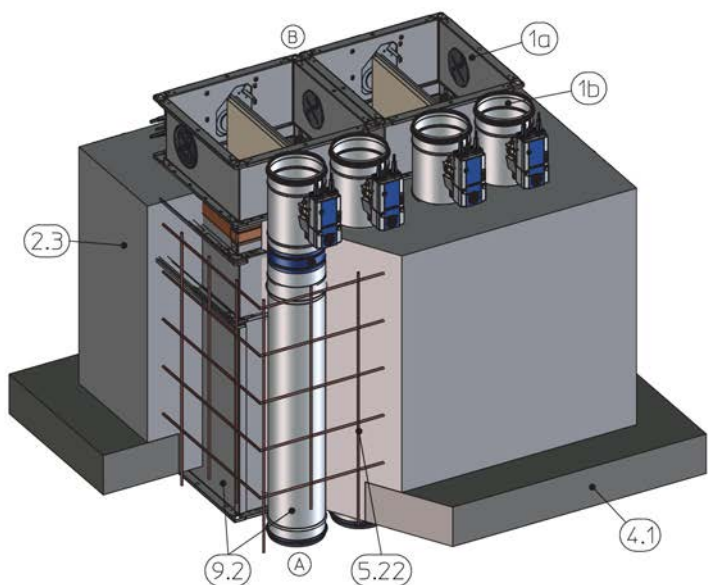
Installazione in muratura con base di calcestruzzo in un soffitto in soletta solido, verticale, occupazione multipla
